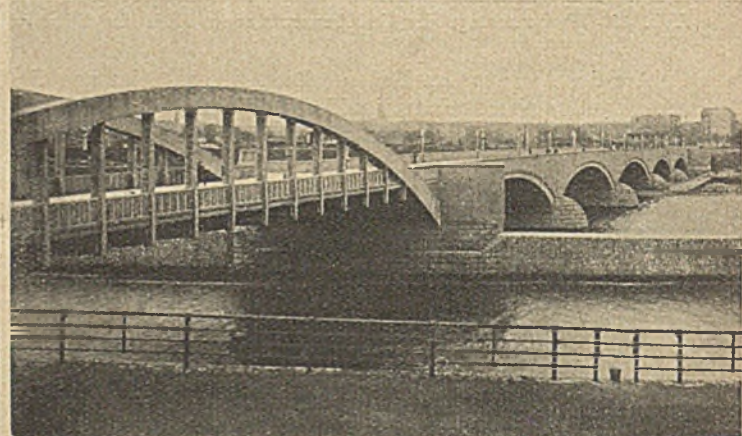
Hindenburg-Brücke in Breslau in umschürtem Gußeisen.
